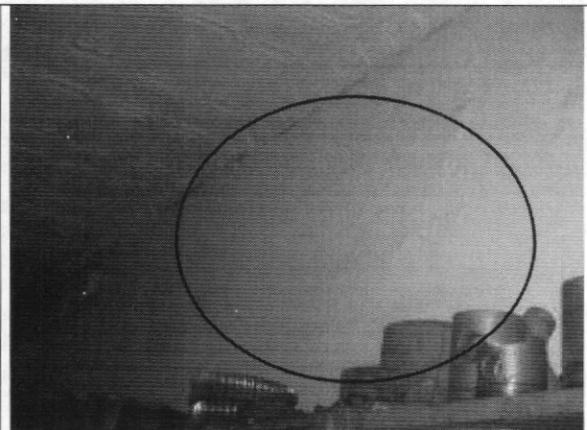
Muros del primer piso en estado regular, fisuras
